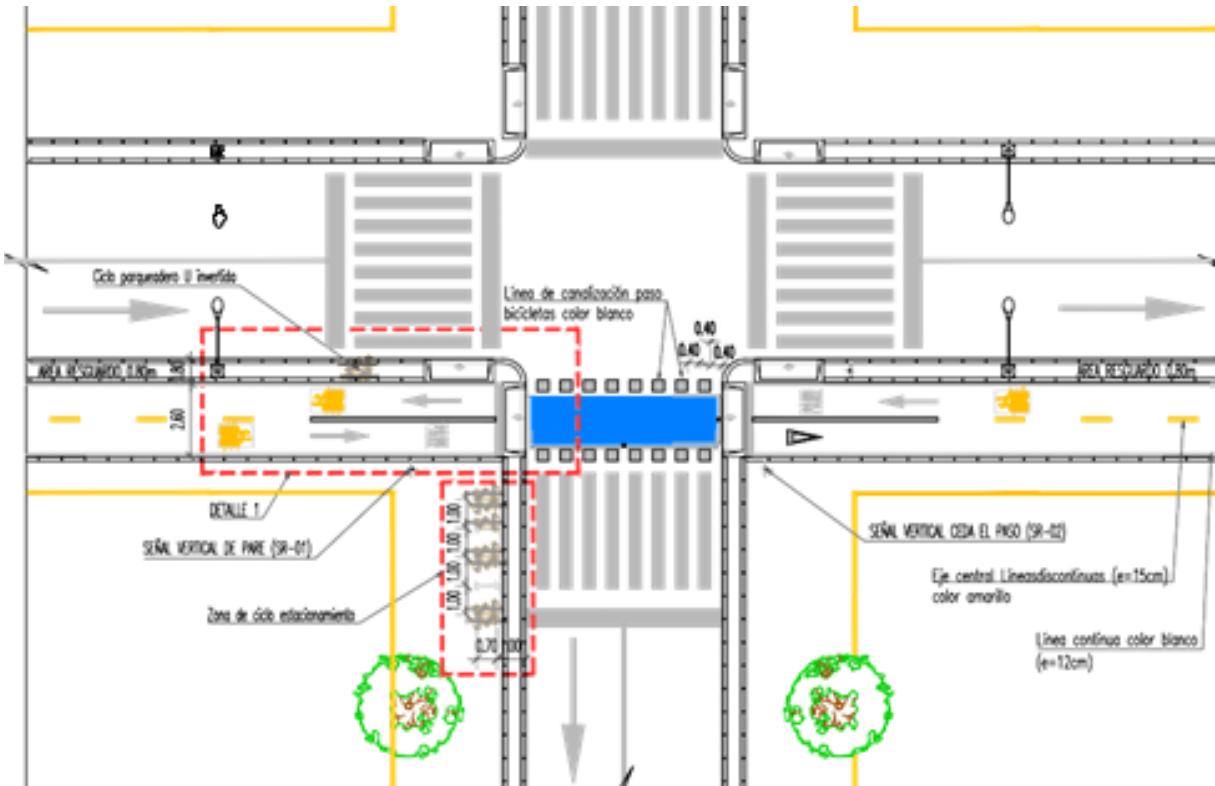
Planta solución de intersección (Fuente: Elaboración DNP)
